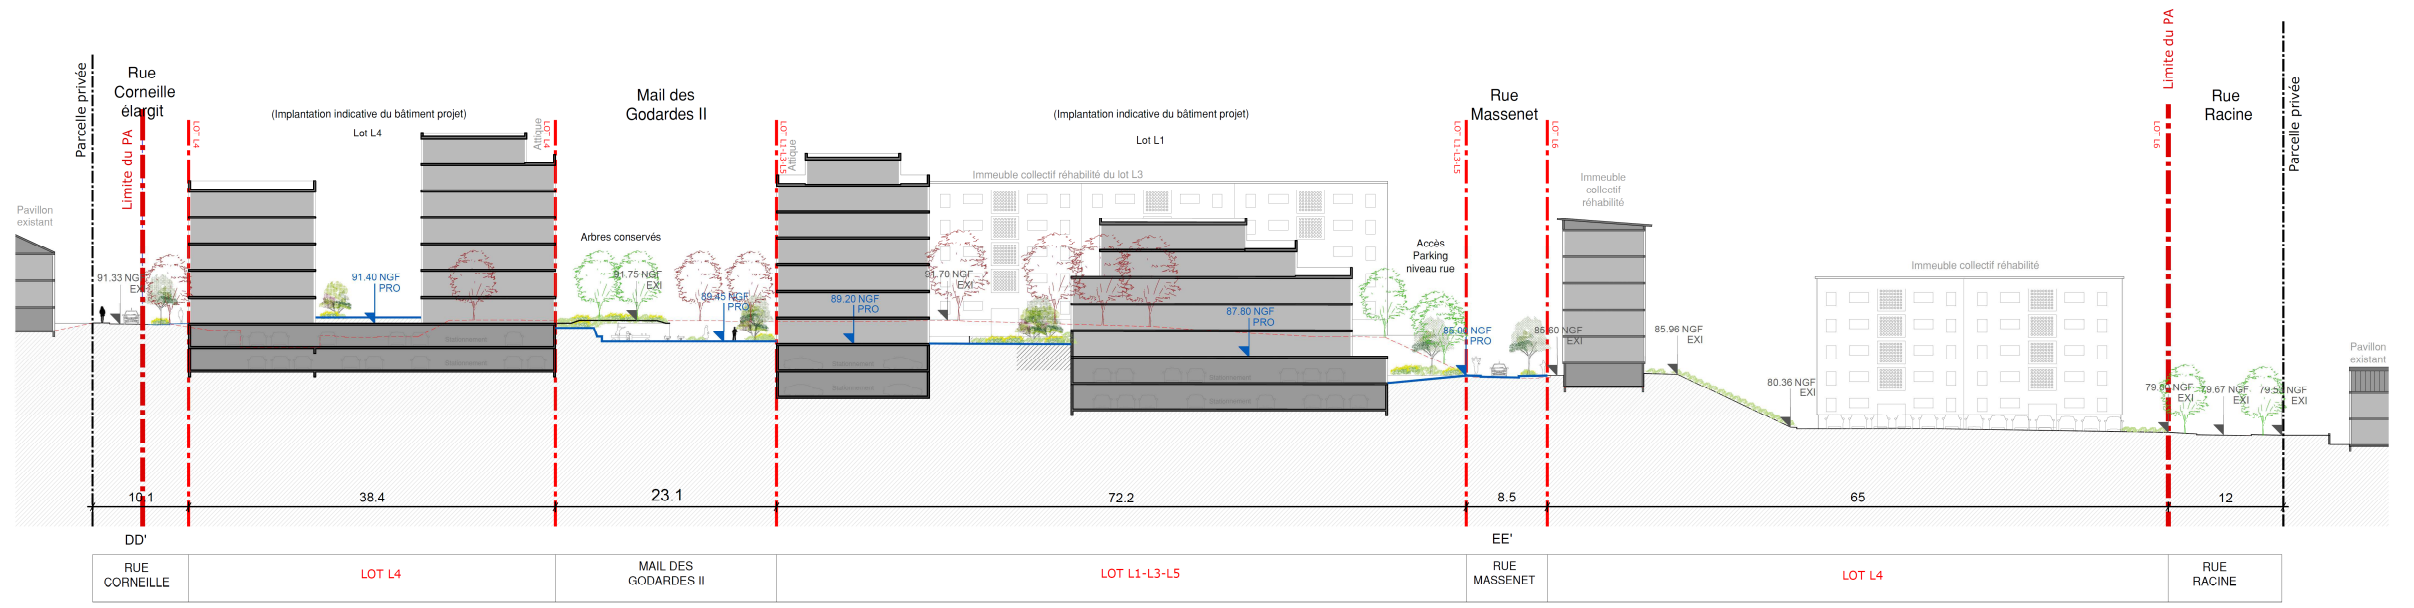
Coupe Ouest-Est de l'existant et du projet. Source : CPAUPE
